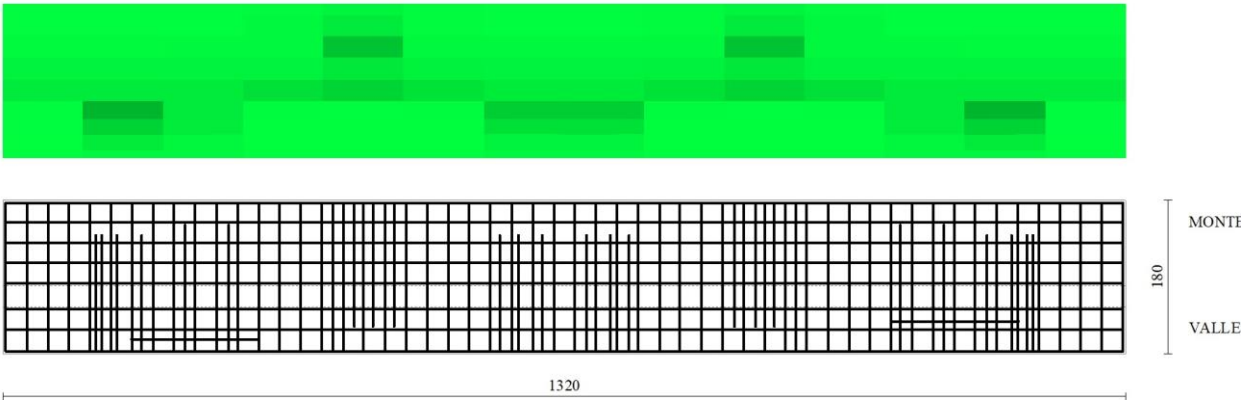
Piastra fondazione dir. Y (Inviluppo)
